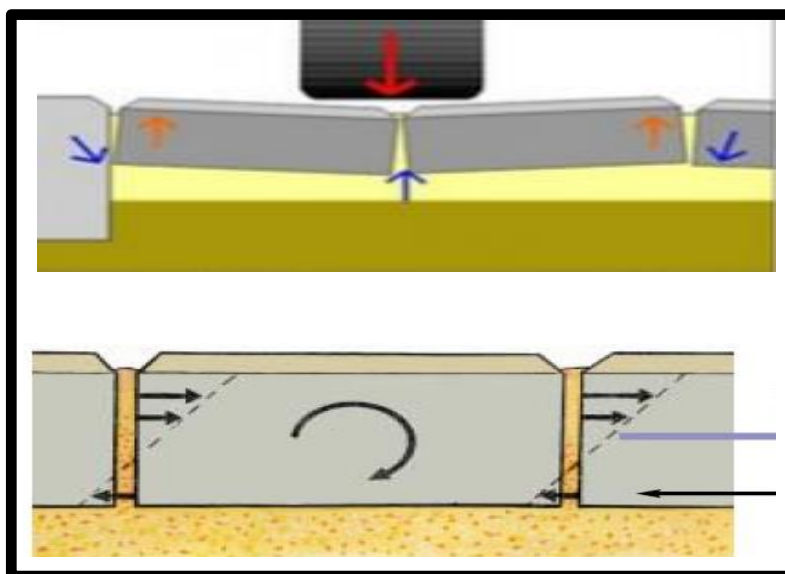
Esquema de cargas dinámicas que actúan en un pavimento adoquinado. (Página web: SETP – Small Element Pavement Technologists)
